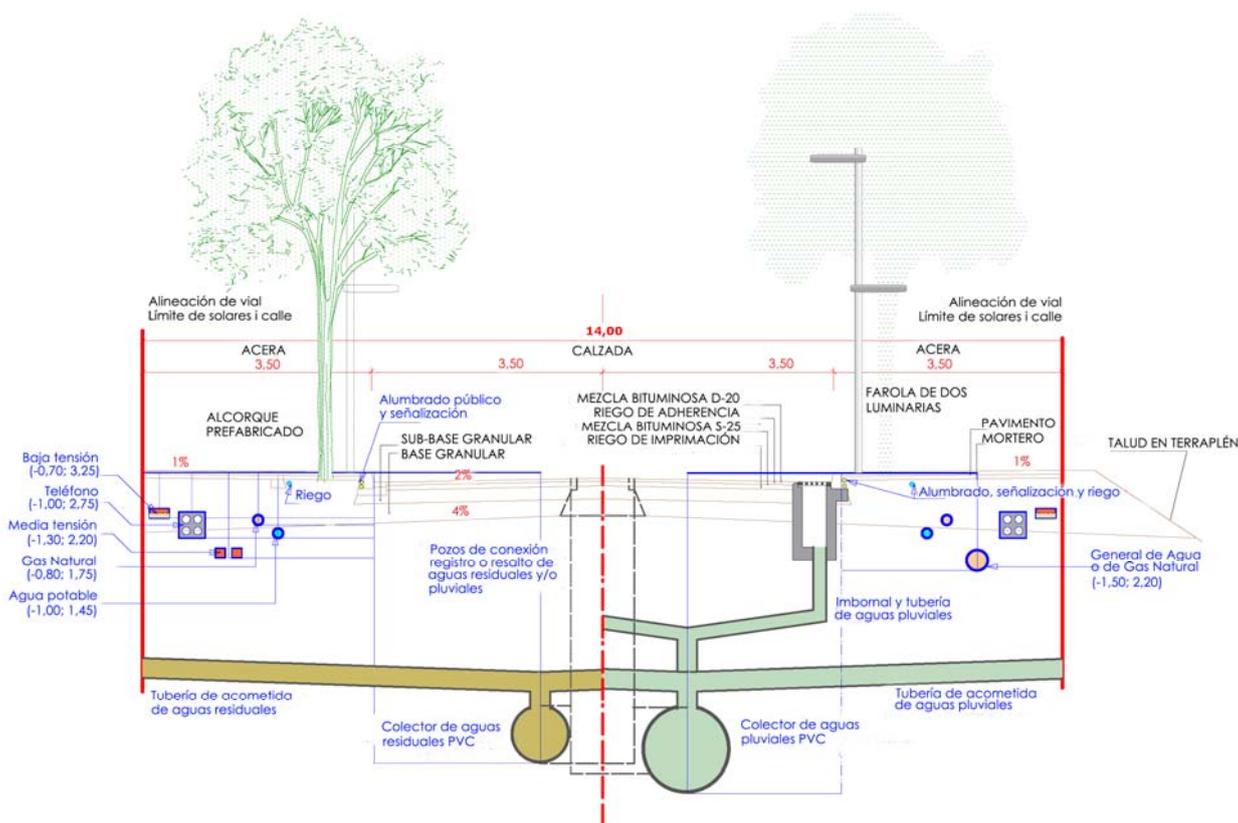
Sección tipo de una calle, con sistema de alcantarillado separando aguas residuales de las de lluvia. Incluye servicios de agua potable, electricidad en media y baja tensión, gas natural, telefonía, alumbrado público, arbolado y riego⁴⁹.
